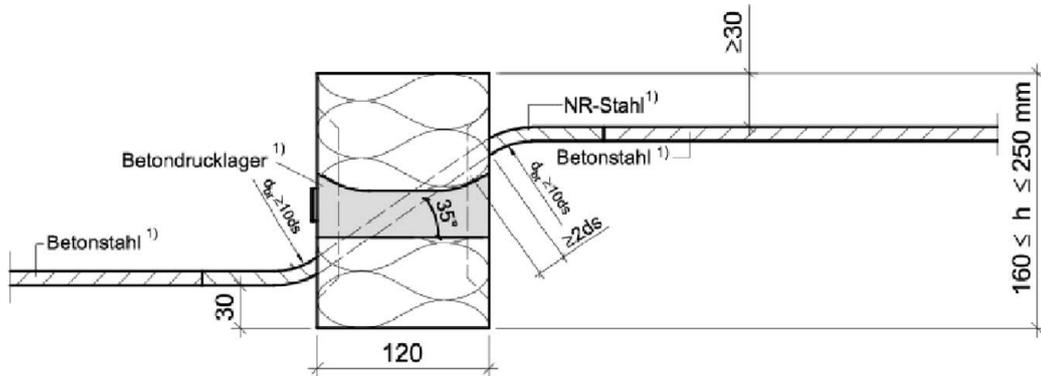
Schöck Isokorb® T Typ Q-ID mit Betondrucklager in eingebautem Zustand mit Vergussfuge
